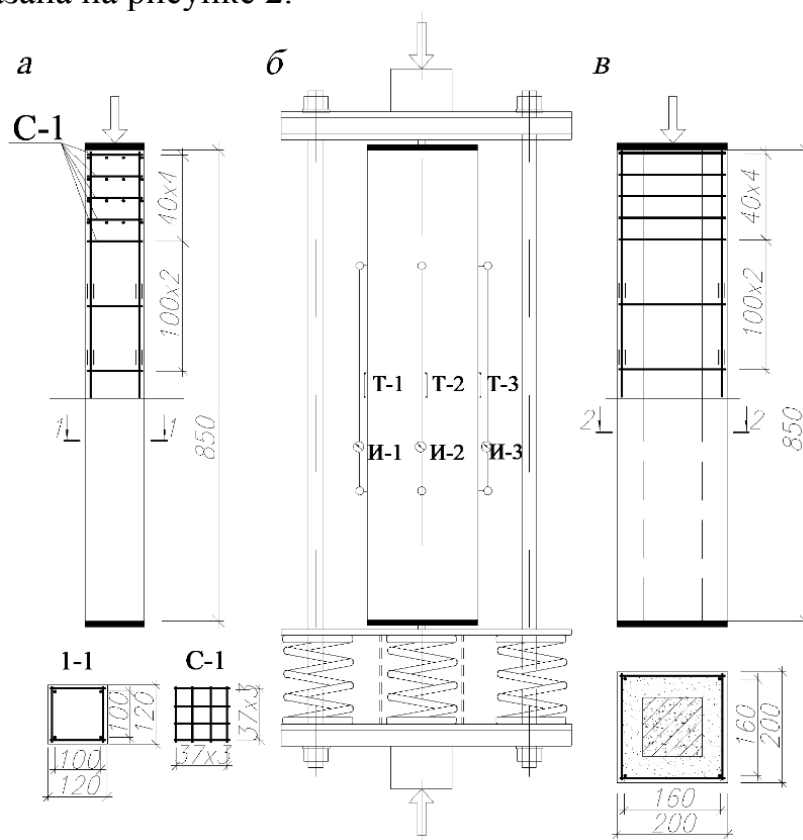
Экспериментальное исследование сжатых железобетонных элементов, усиленных под нагрузкой: а) конструкция опытных элементов; б) схема установки для длительного нагружения при усилении и испытании с расположением приборов; в) конструкция опытных элементов после усиления
